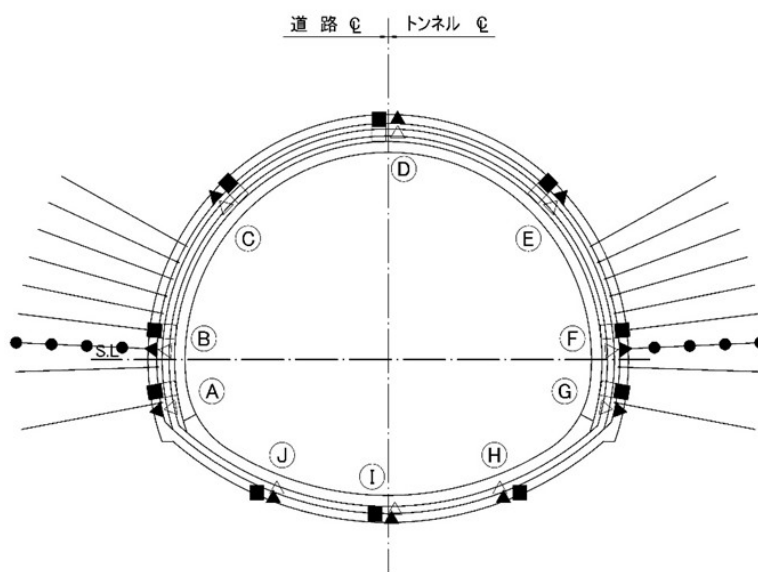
音中トンネル 計測 B 断面図 (P=8, 440)
